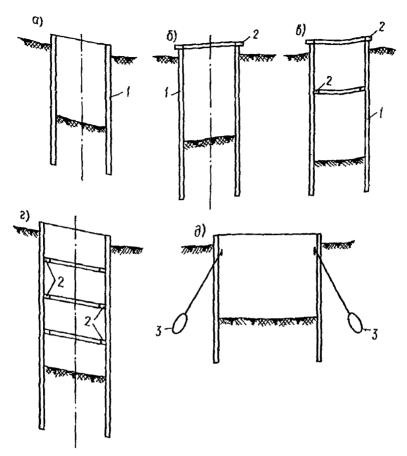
Заглубленные сооружения, прямоугольные в плане: а - консольная стенка; б, в - стенки с креплением распорками; г,д - стенки с креплениями грунтовыми анкерами; 1 - стенка, 2 - распорка, 3 - грунтовые анкера
